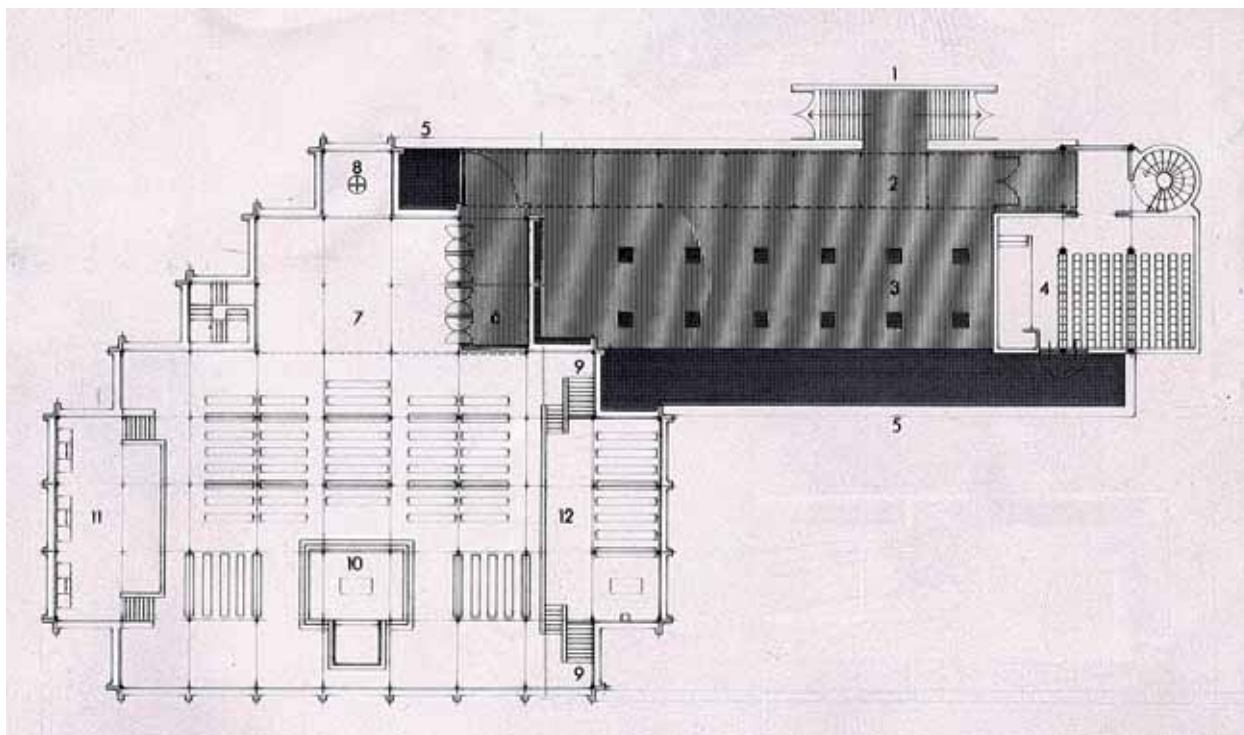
Parroquia de Almendrales. Planta de la versión construida. Archivo García de Paredes
